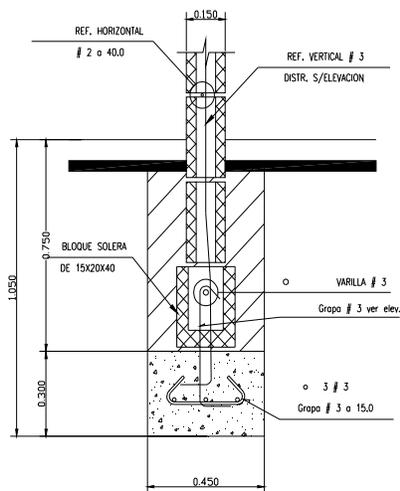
Detalle de solera de fundación y pared, para el sistema de bloque de concreto
